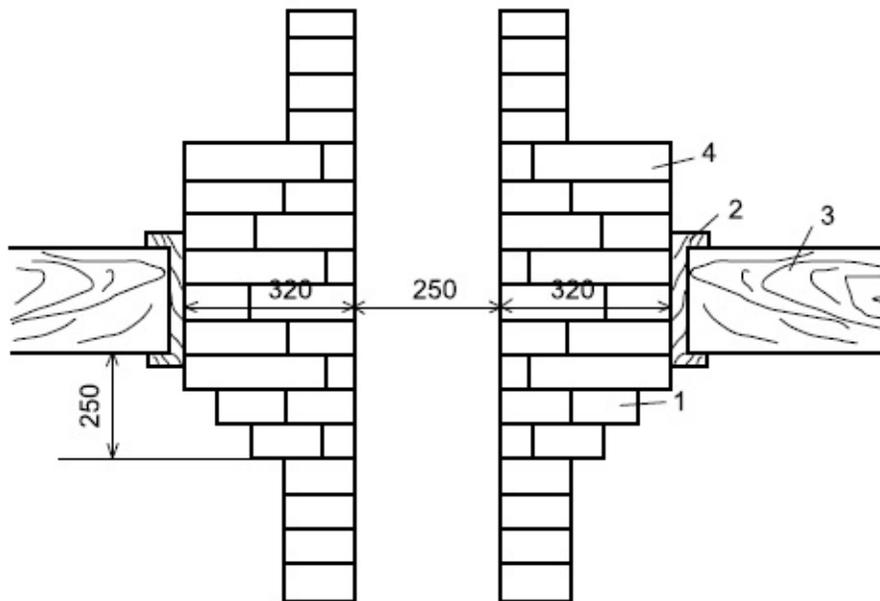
Способы кладки распушек: 1 – распушка; 2 – теплоизоляция; 3 – деревянные перекрытия; 4 – распушка над перекрытием
